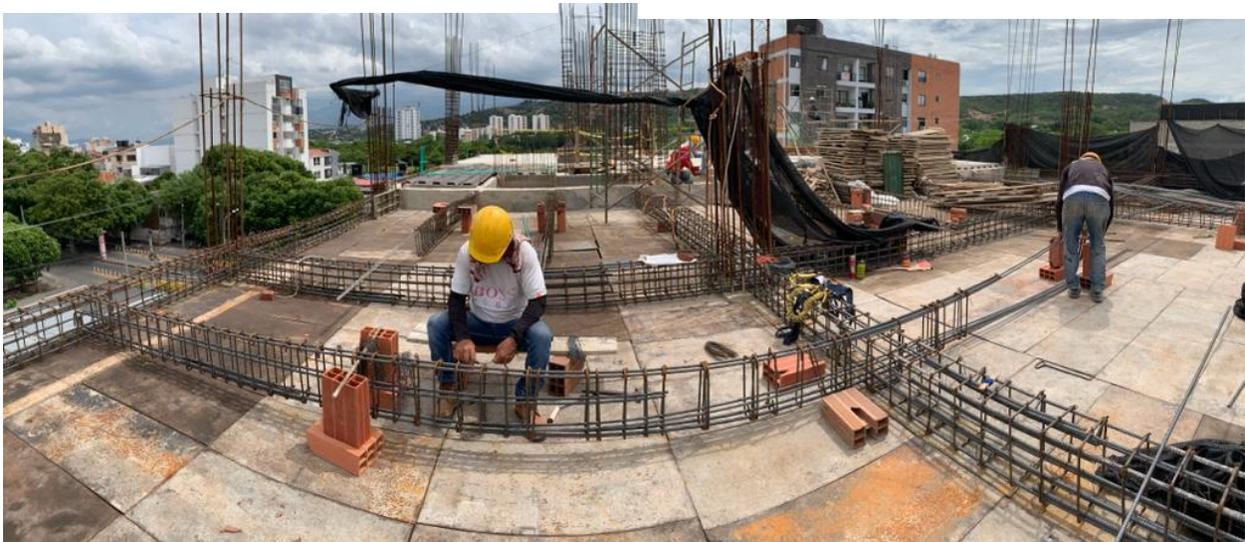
Armado de vigas nivel 5 segundo tramo ejes 1-4 (E-H)
